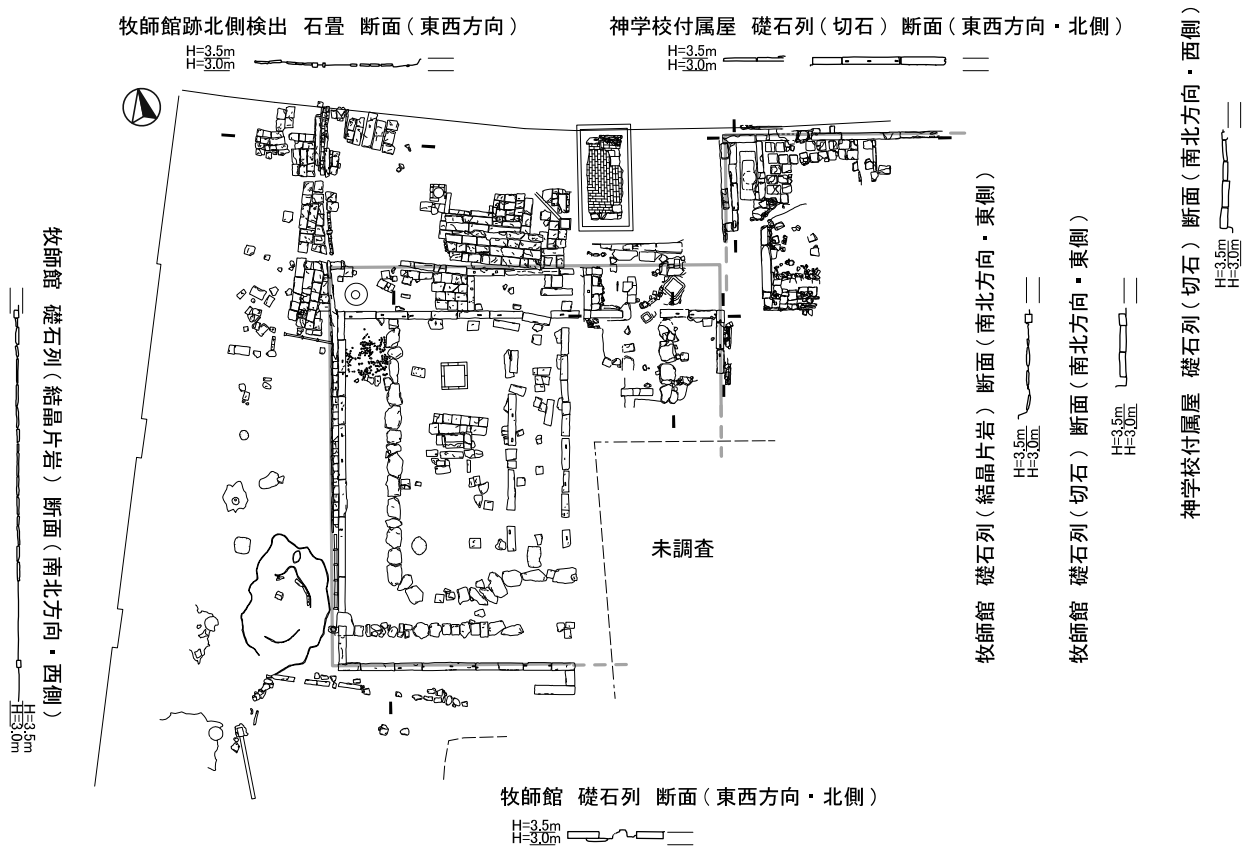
旧牧師館・神学校付属屋跡 平面図・断面図 (S=1/300)
